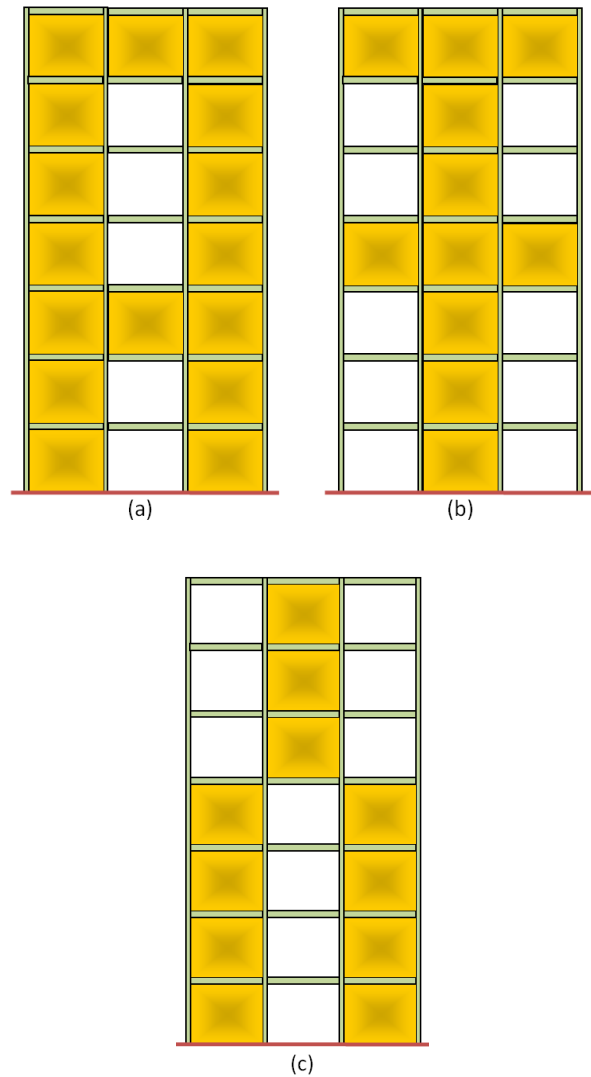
Configuraciones alternativas para muro de corte con placas de acero.
